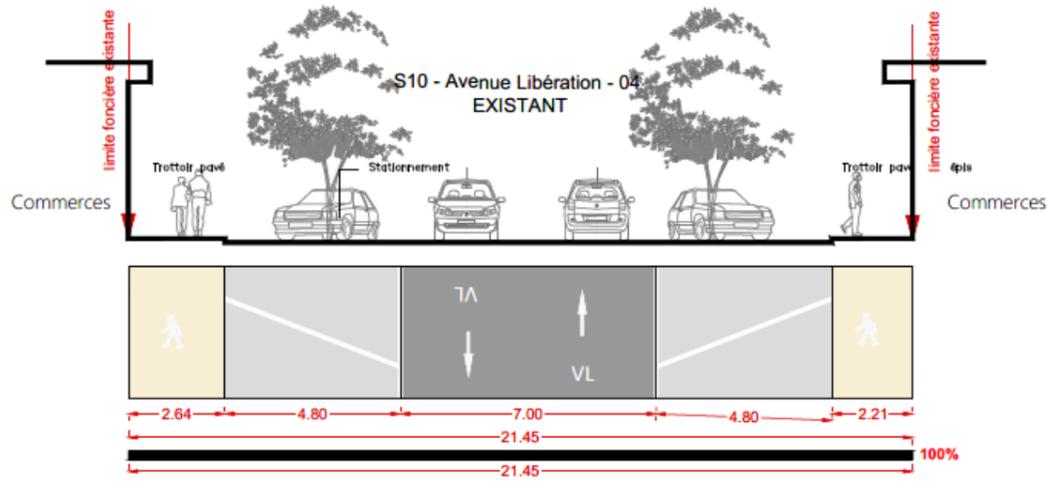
Profil existant sur l'avenue Libération entre les avenues Maréchal Foch et Hoch
